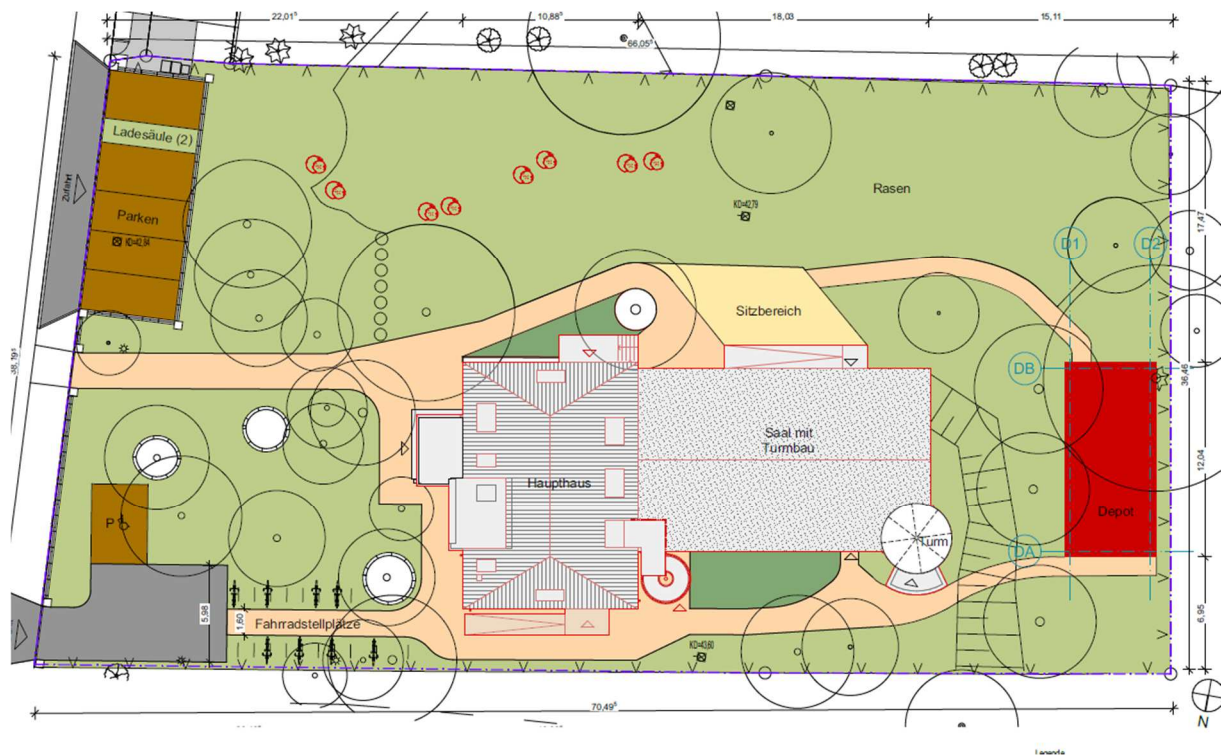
Objektplanung für die Sanierung und Umgestaltung des ehemaligen Kirchengebäudes
